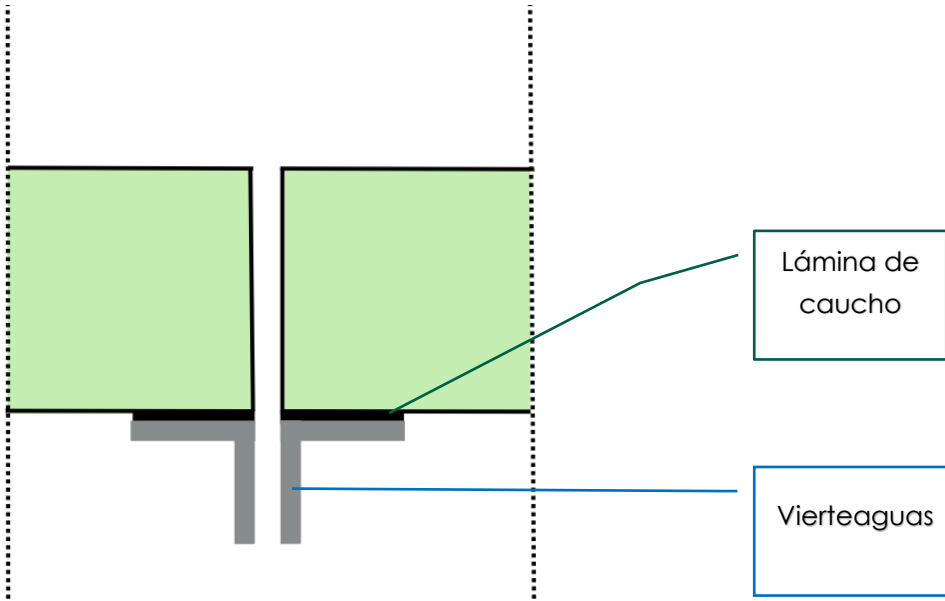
Colocación de vierteaguas a ambos lados de las juntas de los marcos, con lámina de caucho.
